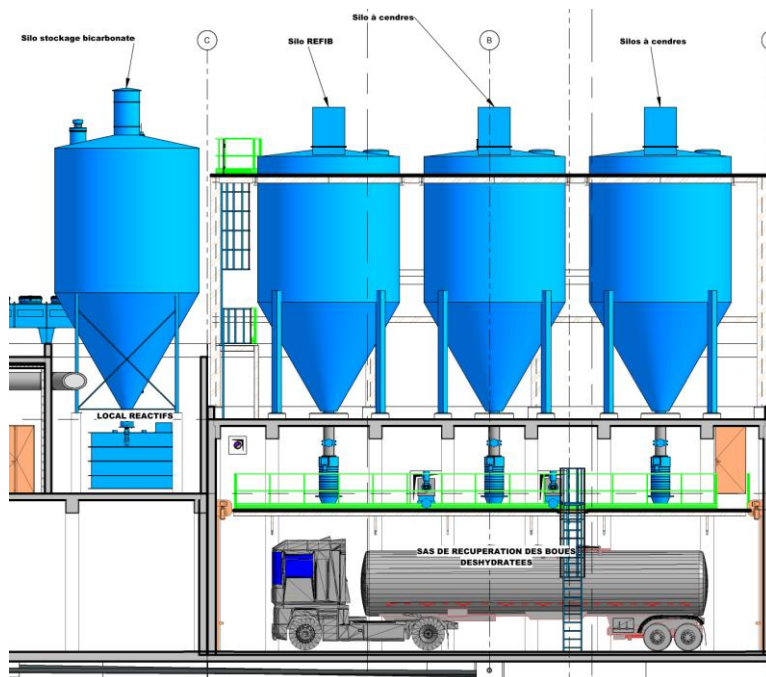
Vue en coupe des silos de stockage boues déshydratées
